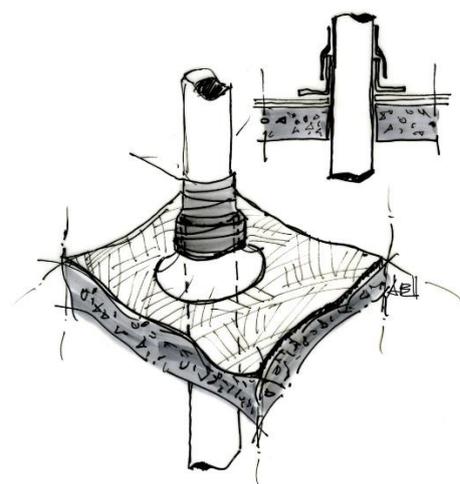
Ilustração de pormenor do reforço da membrana na zona de atravessamento da conduta de um sistema de despressurização instalado abaixo do pavimento
